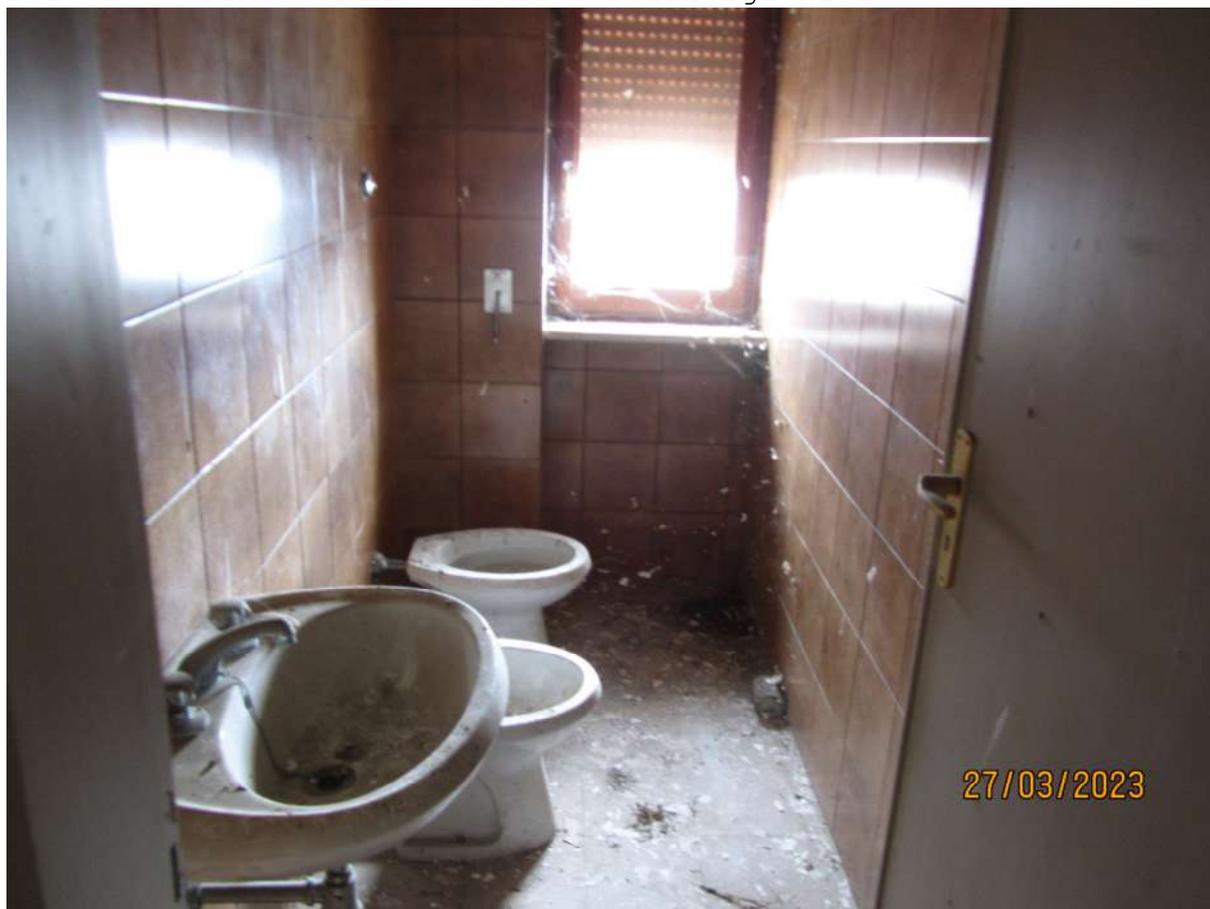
PIANO PRIMO - Boyler elettrico zona servizi.
